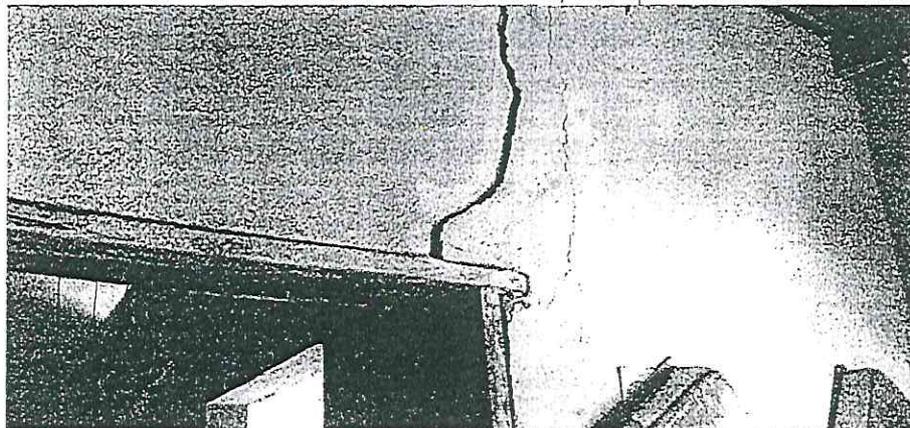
Muro de contenção ao lado da casa em movimento.
